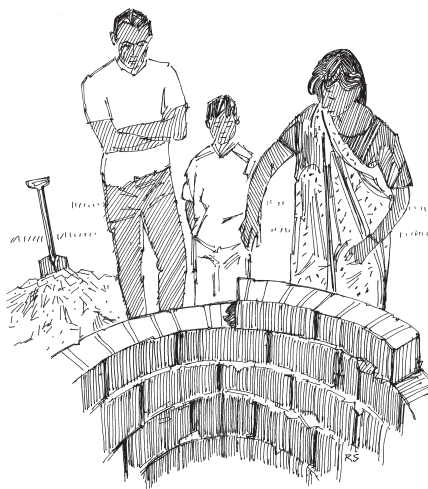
Discussion avec les usagers sur la hauteur du parapet
